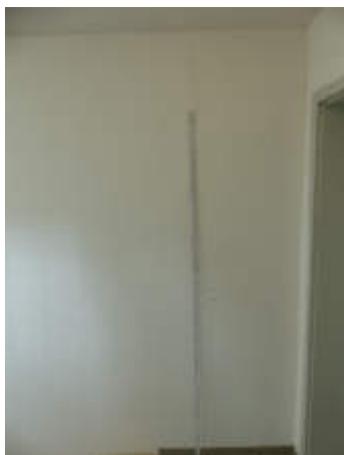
Baumängel/Bauschäden Wandriss im Treppenhaus (exemplarisch) Risslänge ca. 240 cm
